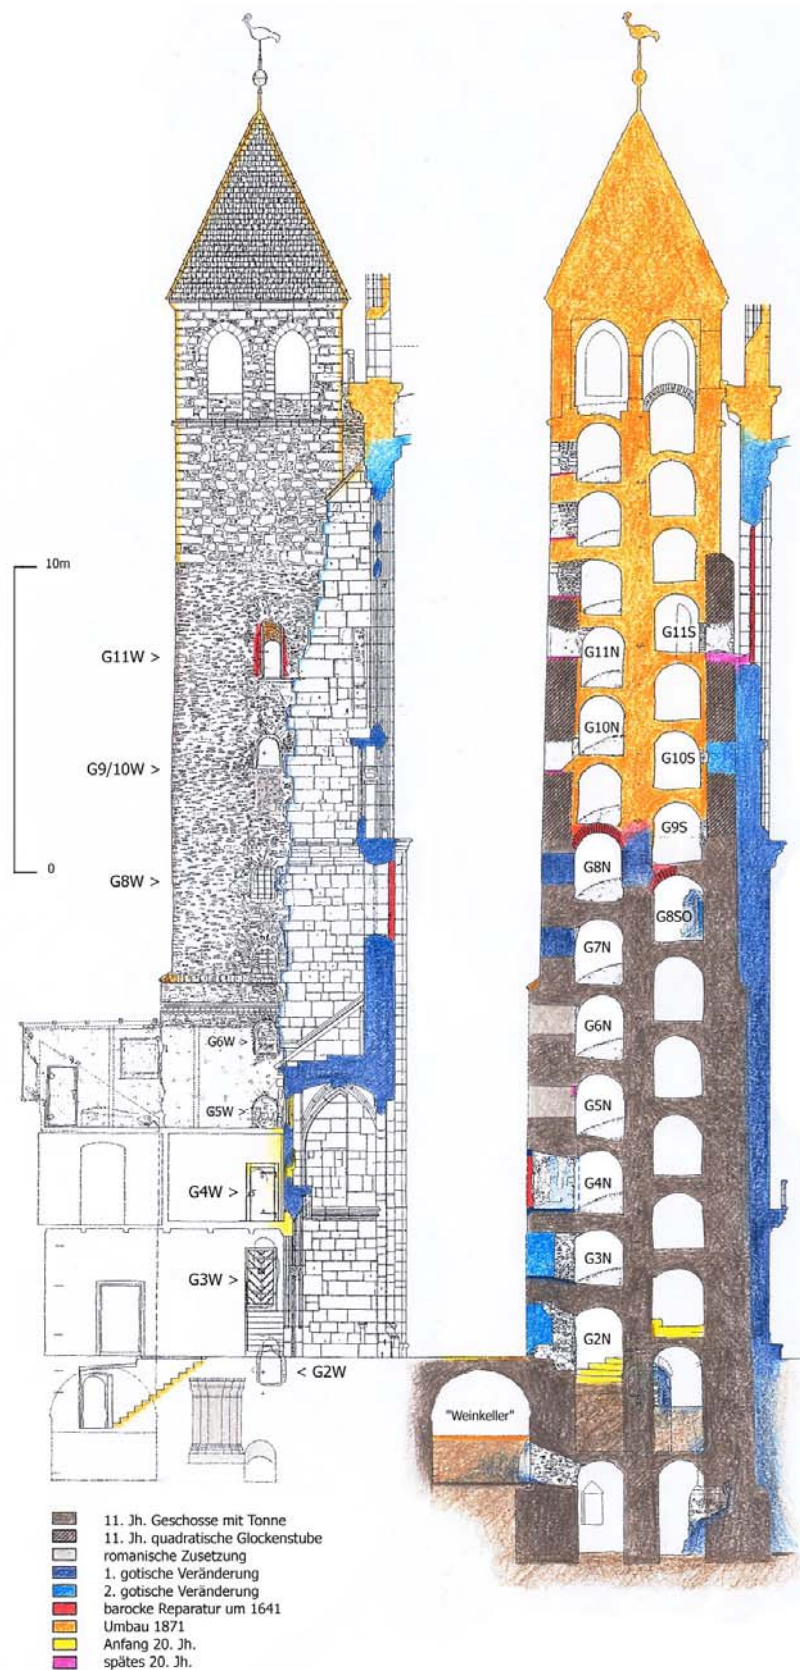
Eselsturm, Westfassade und Schnitt nach Osten: Baualtersplan.
